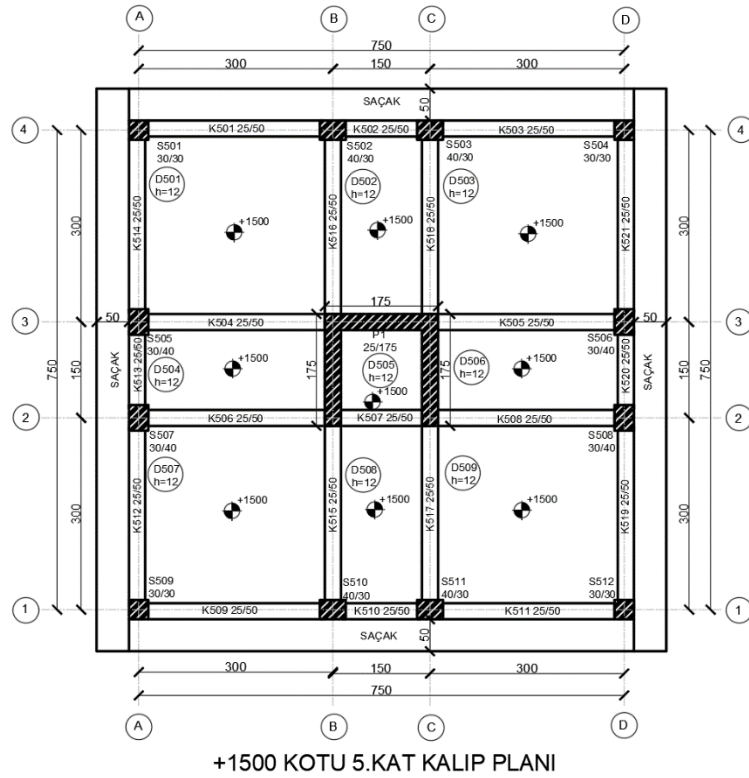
Yeniden tasarlanan kat kalıp planı
